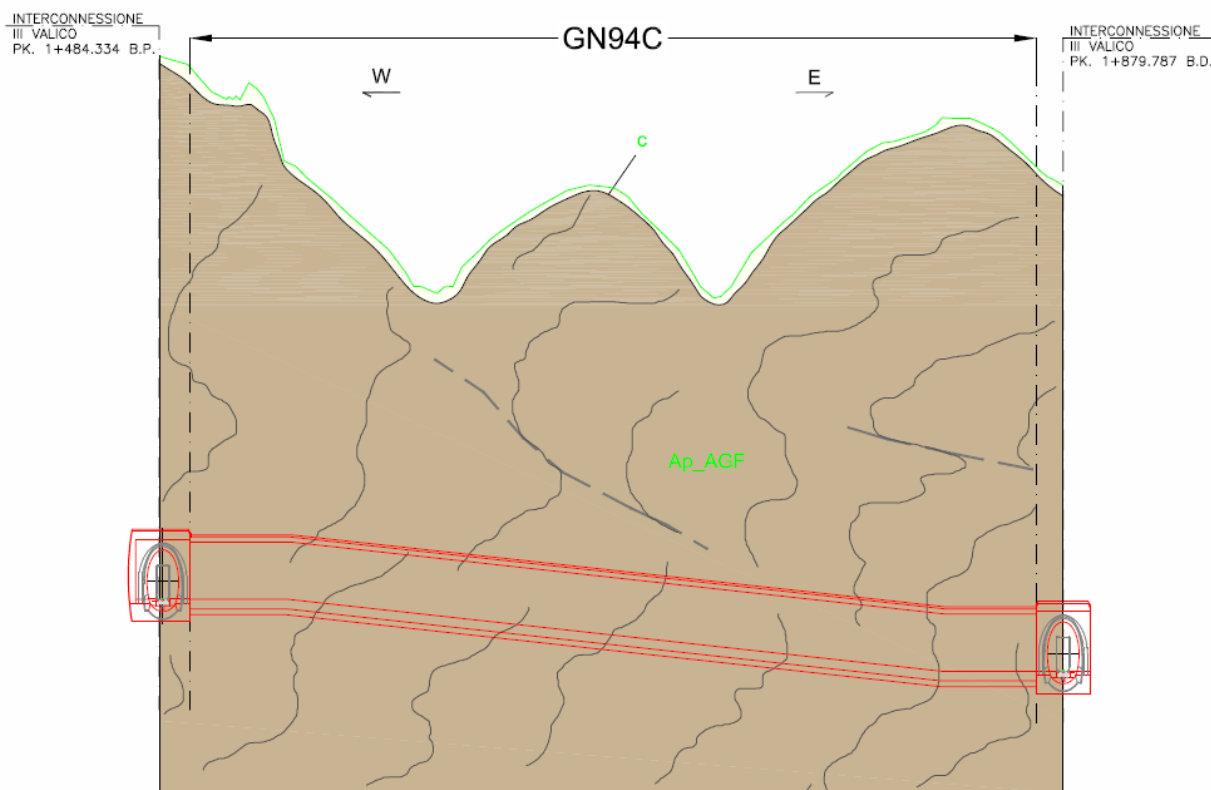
Stralcio profilo geomeccanico del by-pass di collegamento
